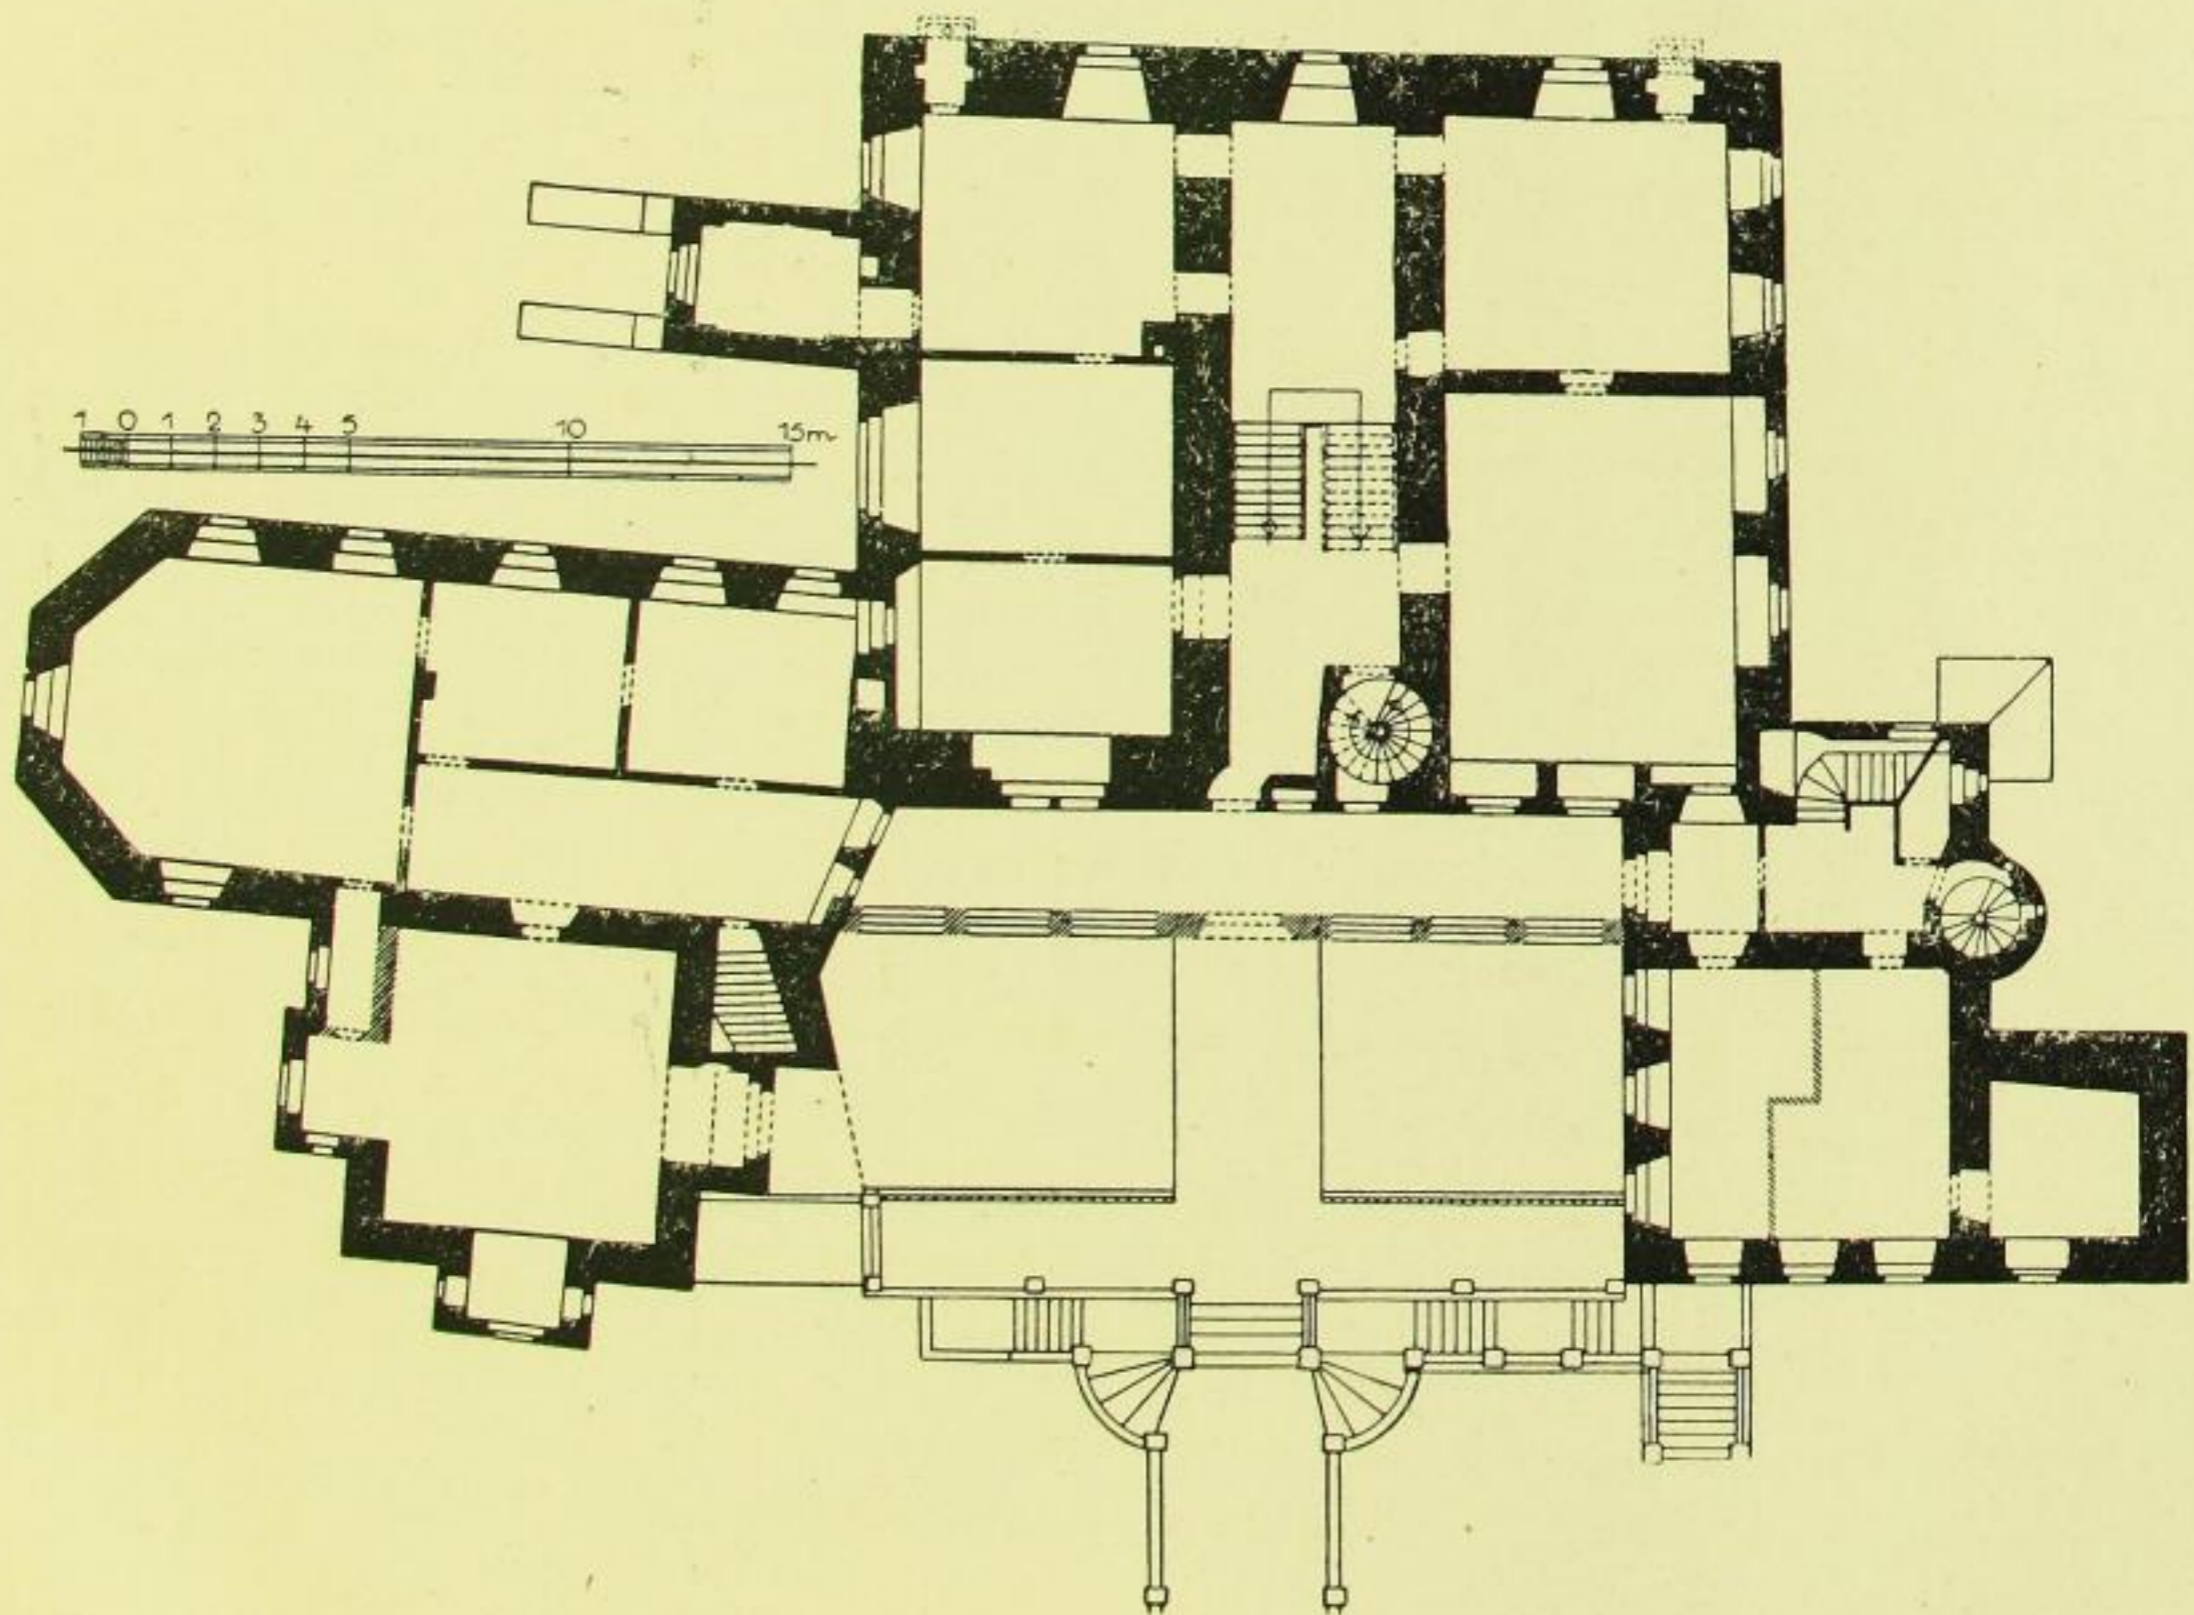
Schleinitz, Schloß, Grundriß des Obergeschosses. Zustand vor 1905.
